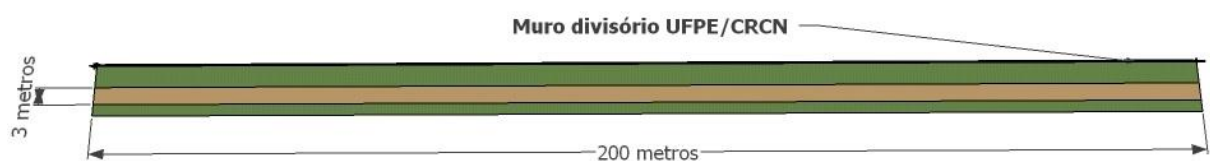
Vista em planta longitudinal da trincheira de infiltração
